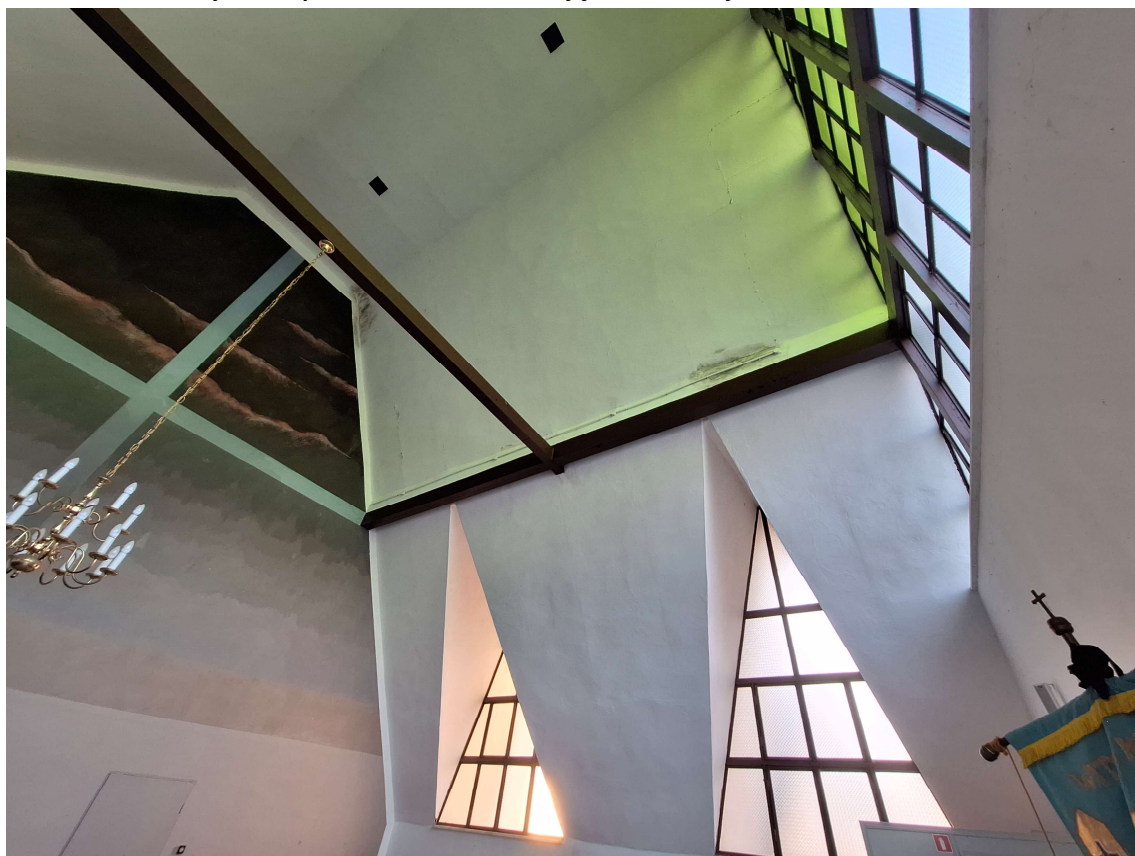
Kaplica cmentarna – istniejąca konstrukcja stalowa - widok 2
